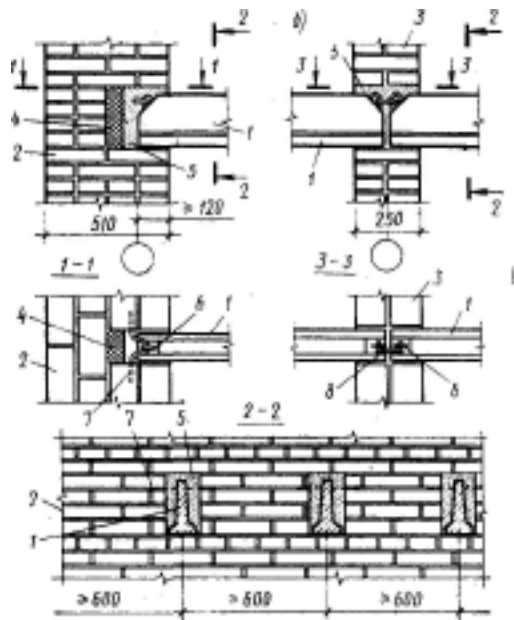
Детали опирания сборных железобетонных балок часторебристых перекрытий на каменные стены:
